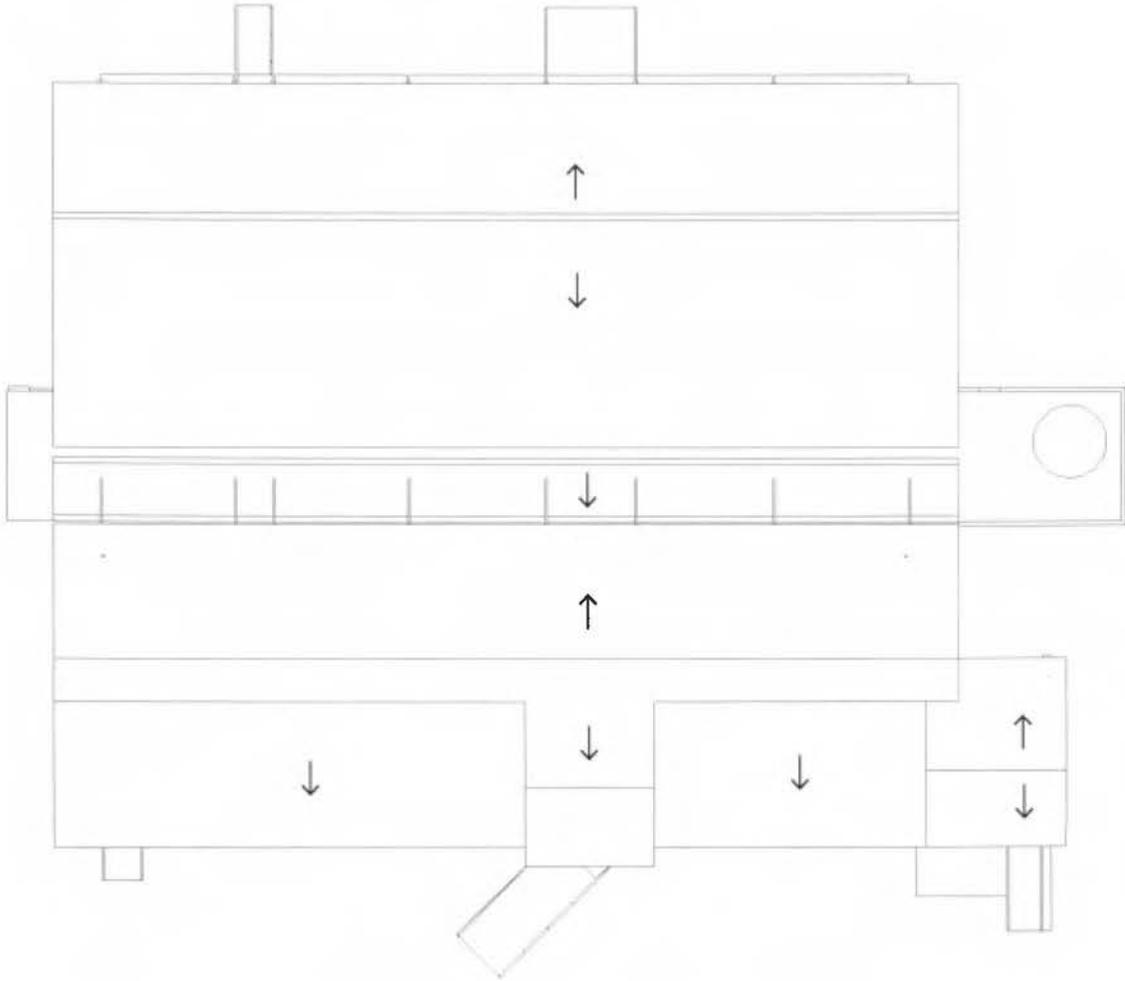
Planta de Cubiertas del edificio. Elaborada por la autora.
